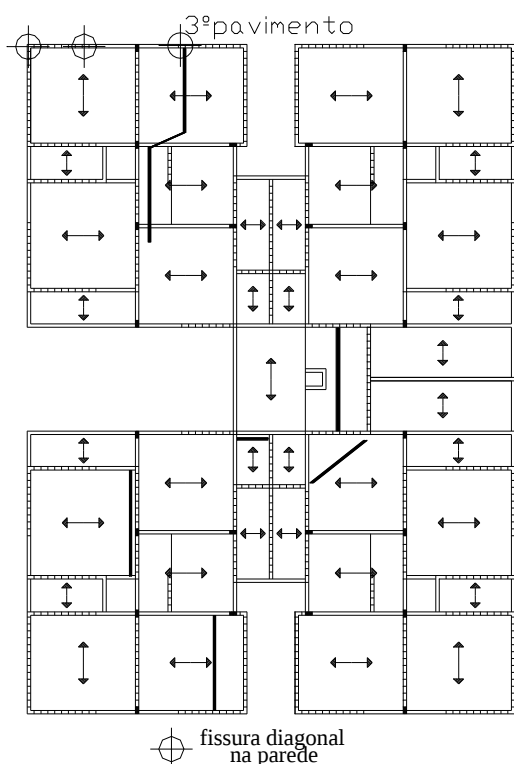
Panorama de fissuração no 3º pavimento.
